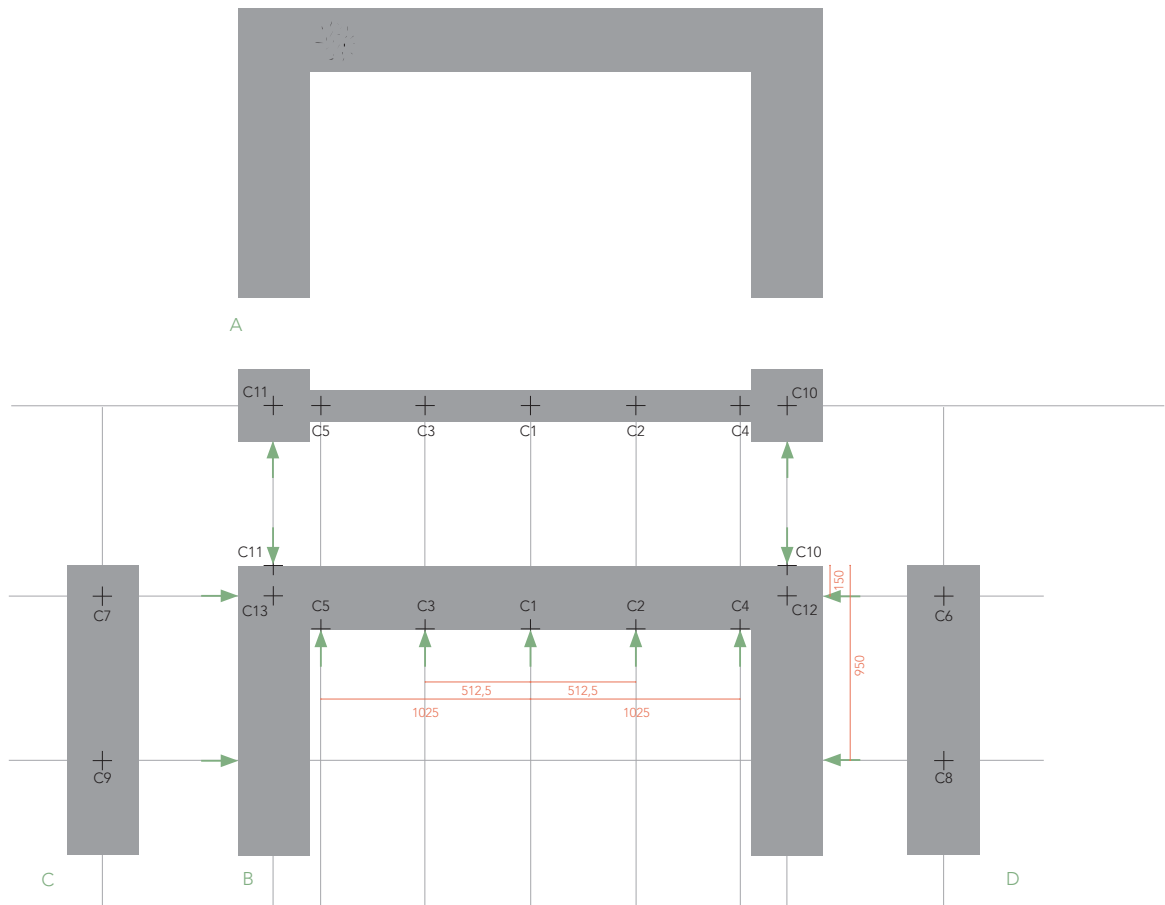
Plan de repérage de l'installation et d'implantation des 13 capteurs sur le portique.
